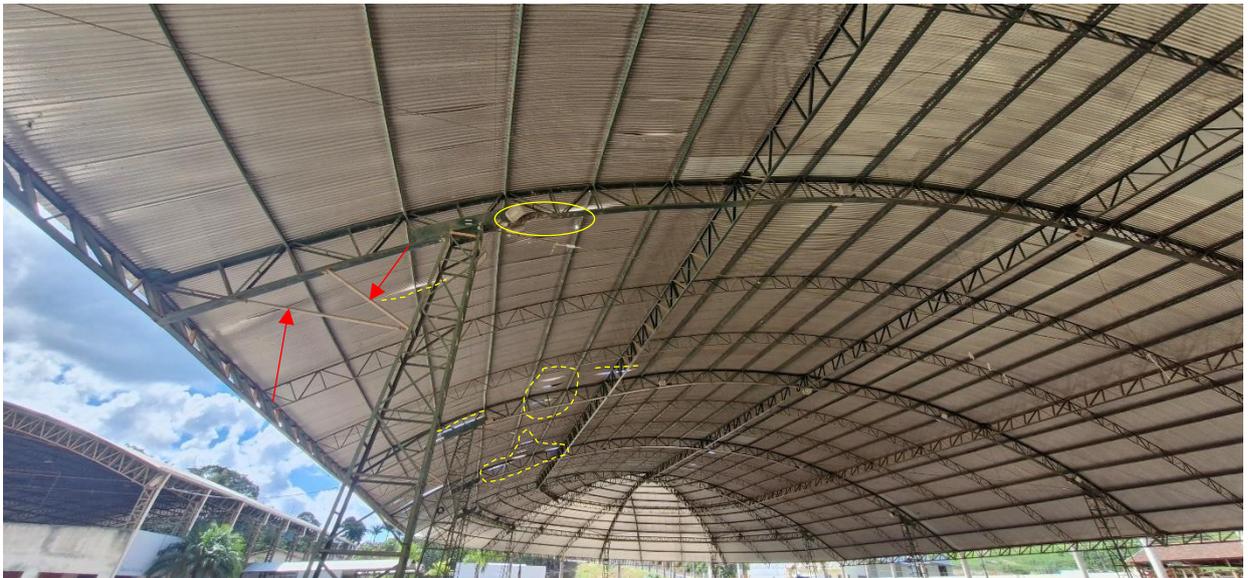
Peças metálicas (indicação das setas vermelhas) aparentemente não fazem parte do projeto original, tendo em vista que se destacam de todo o restante da estrutura. Telhas deformadas devido à movimentação da estrutura metálica que as sustenta. Barra diagonal com FLAMBAGEM.
